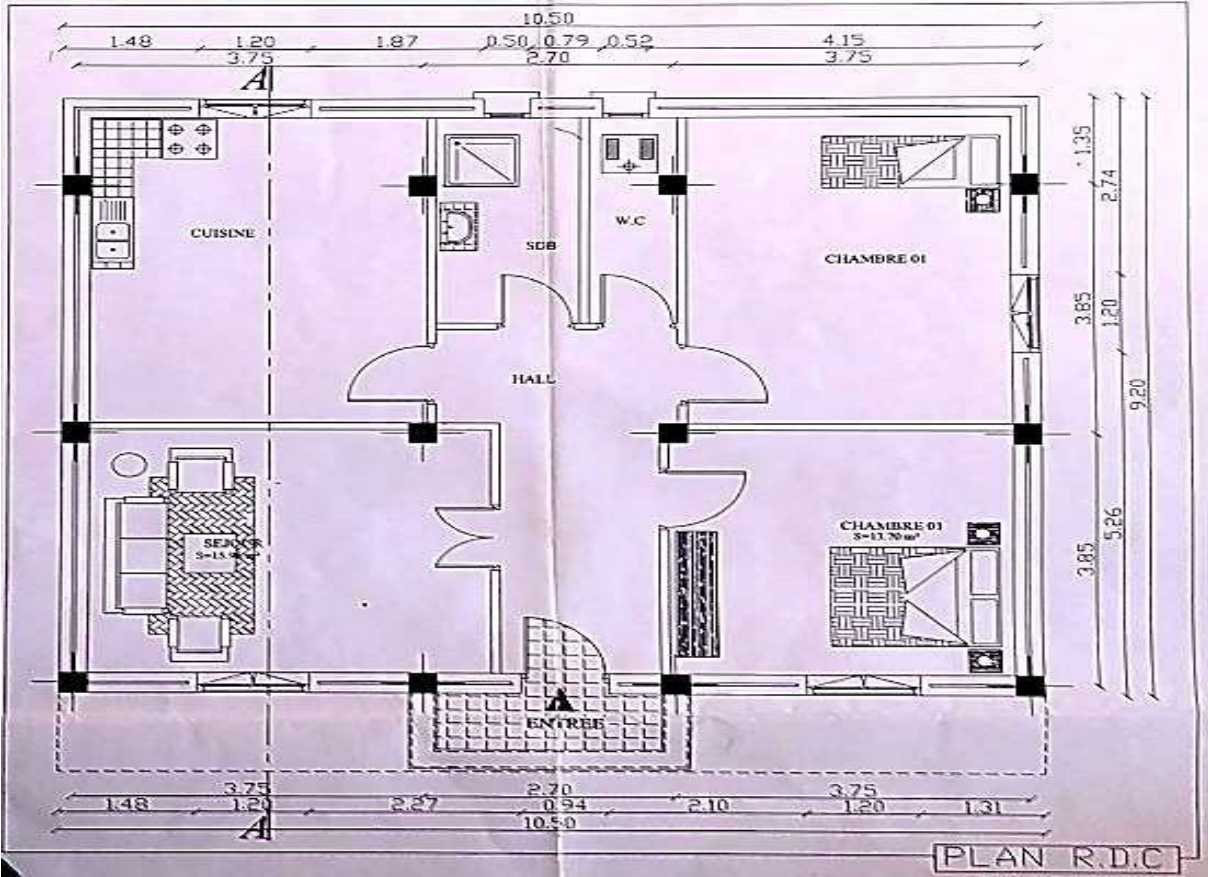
Plan du Rez-de-chaussée du bâtiment 01
